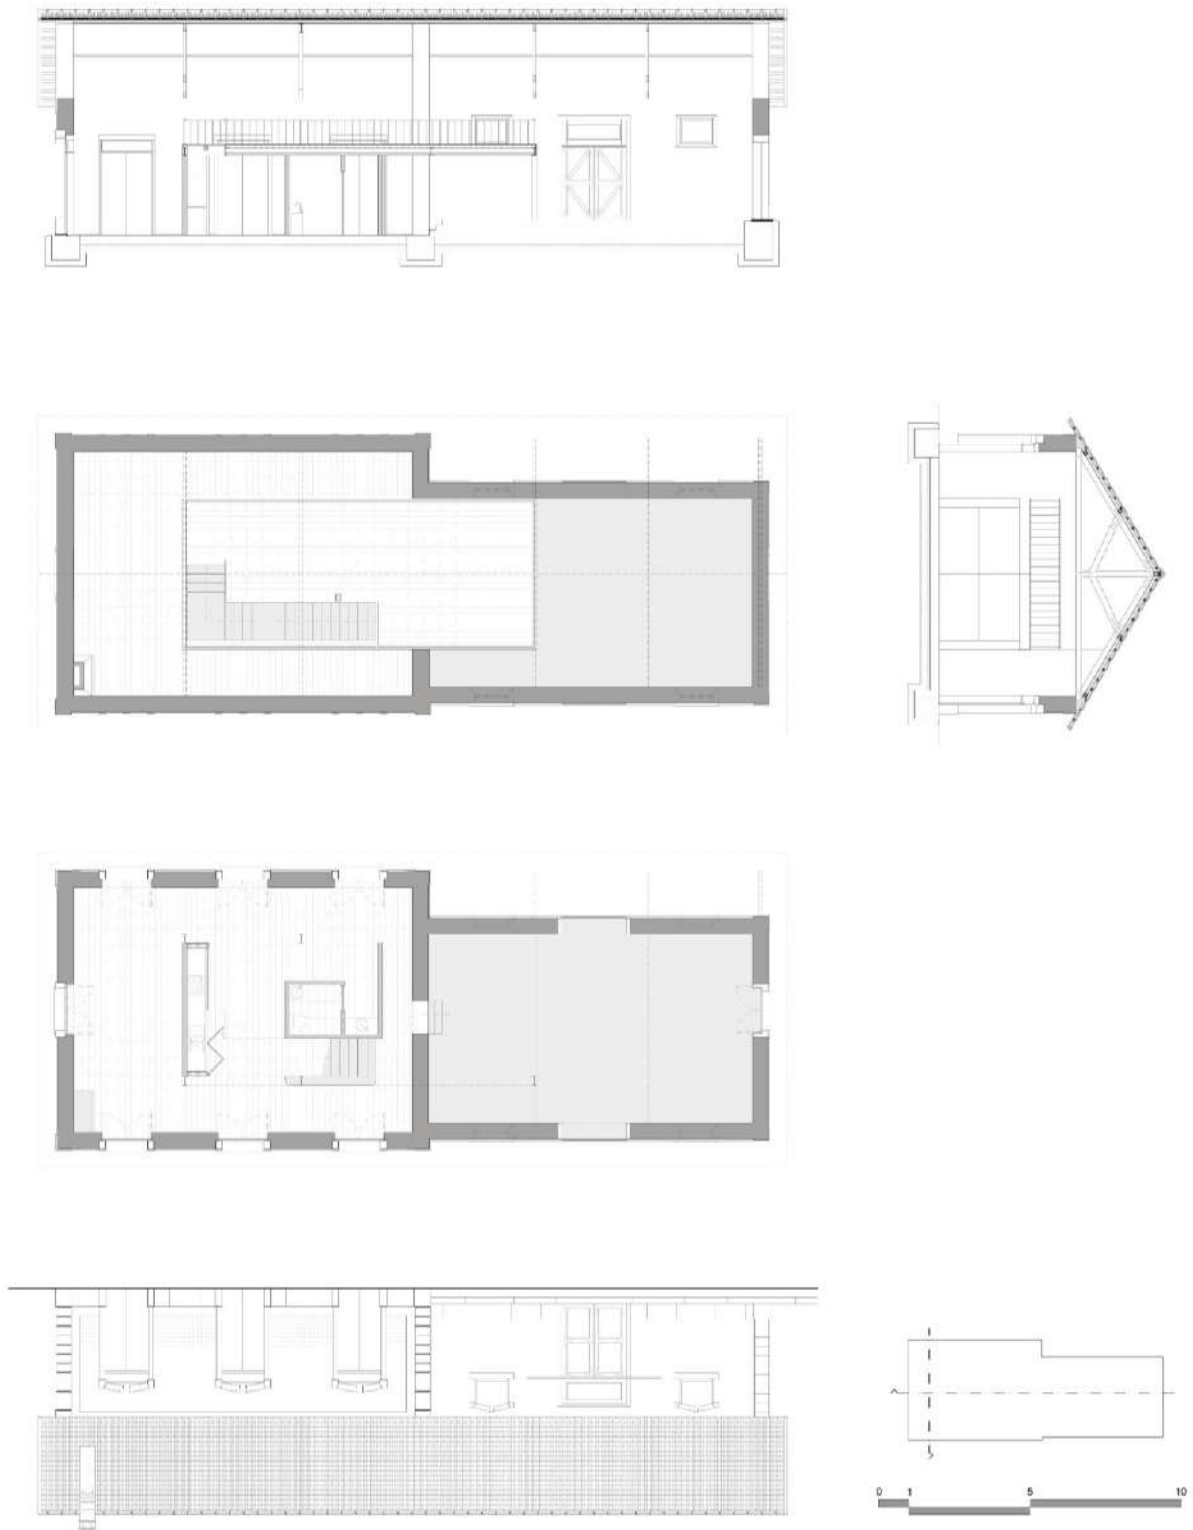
Estação (E.P. e C.C.). Corte longitudinal, plantas dos pisos térreo e superior, alçado principal e corte transversal.
